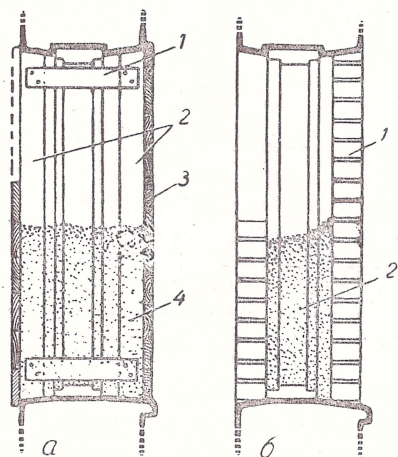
Заделка оконных проемов в каменных стенах: а) досками и грунтовой засыпкой: 1 — схватка; 2 — стойки 5×10 см (4 шт.); 3 — доски или щит по ширине проема; 4 — грунт (засыпается одновременно с забивкой проема досками снаружи); б) кирпичной кладкой с грунтовой засыпкой: 1 — кирпичная кладка на глиняном растворе; 2 — грунт (засыпается по мере возведения наружной стенки)
